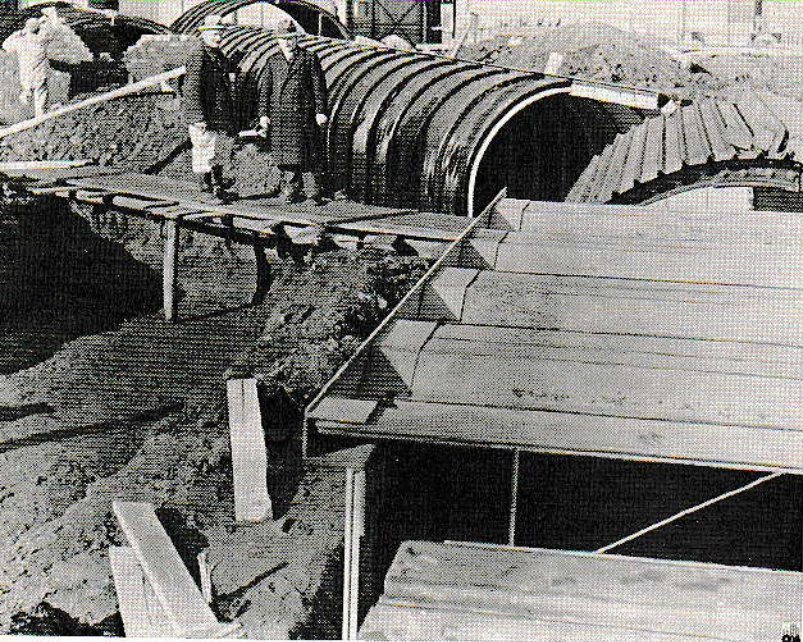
Abri en tôles nervurées prenant appui sur une poutre faîtière.
